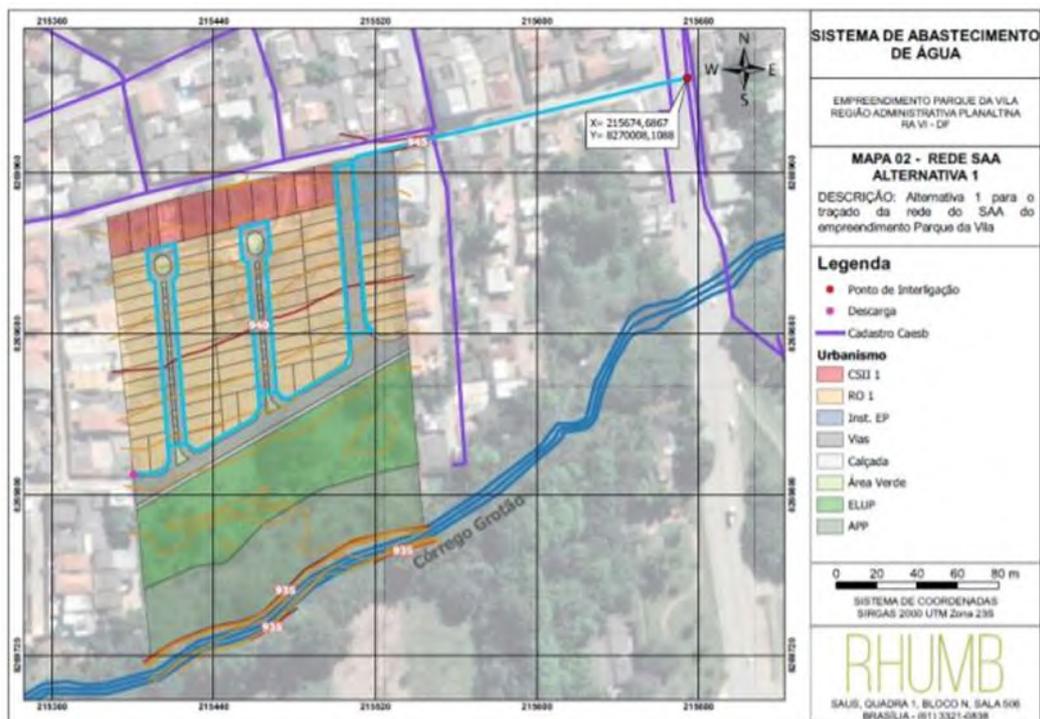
Traçado da rede previsto para abastecimento de água (Fonte MDE-EP)
